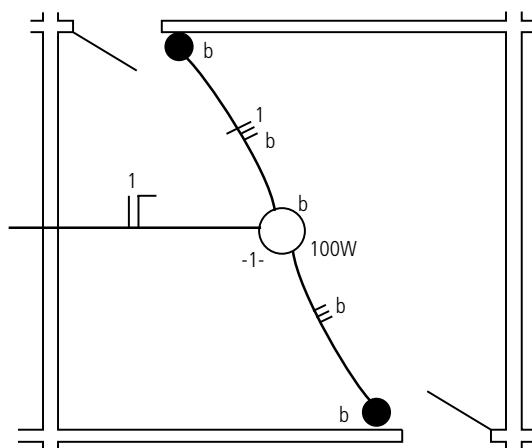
Interruptor paralelo: representação da ligação em planta
